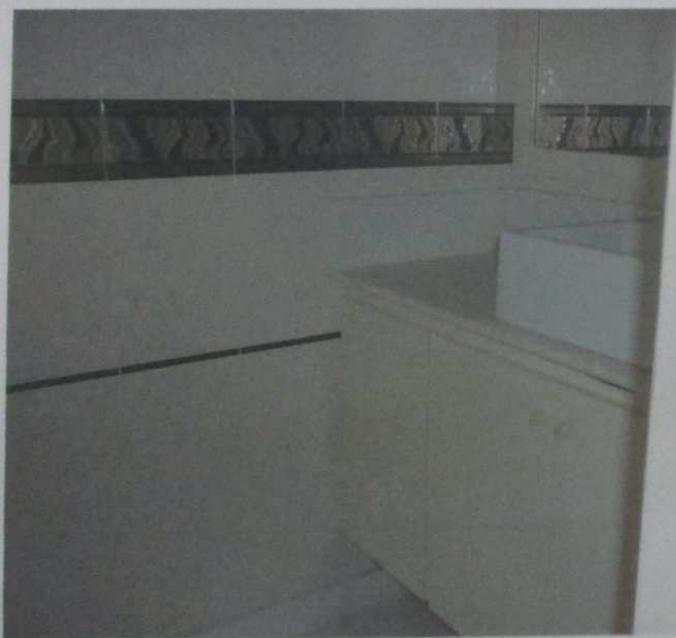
Vista do banheiro da 2ª suíte do imóvel.
